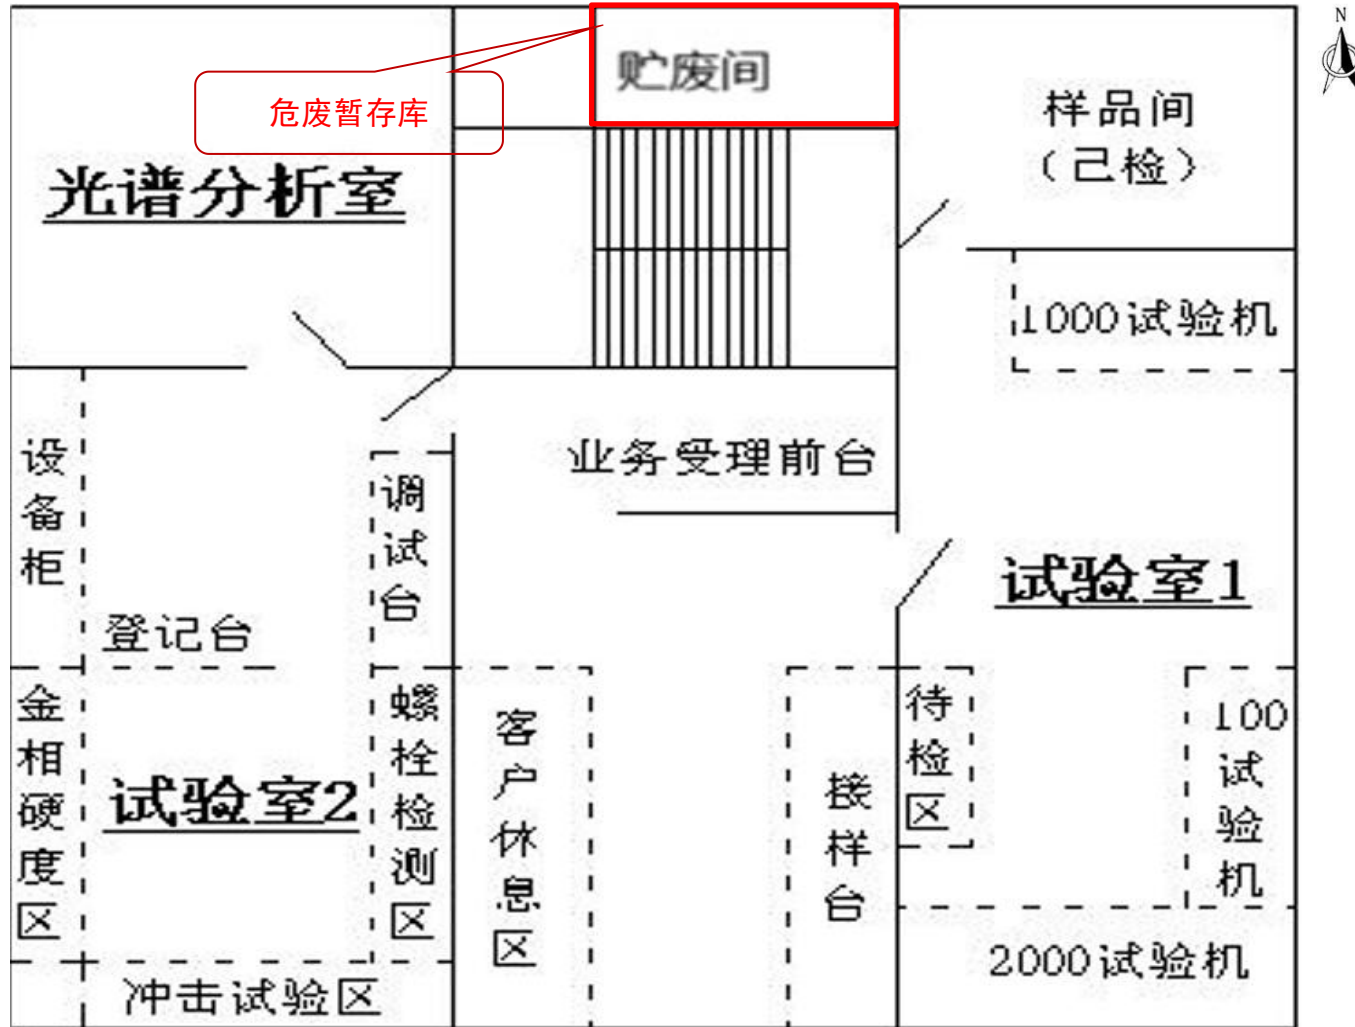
(1) 公司办公用房平面布置示意图 (一层)
